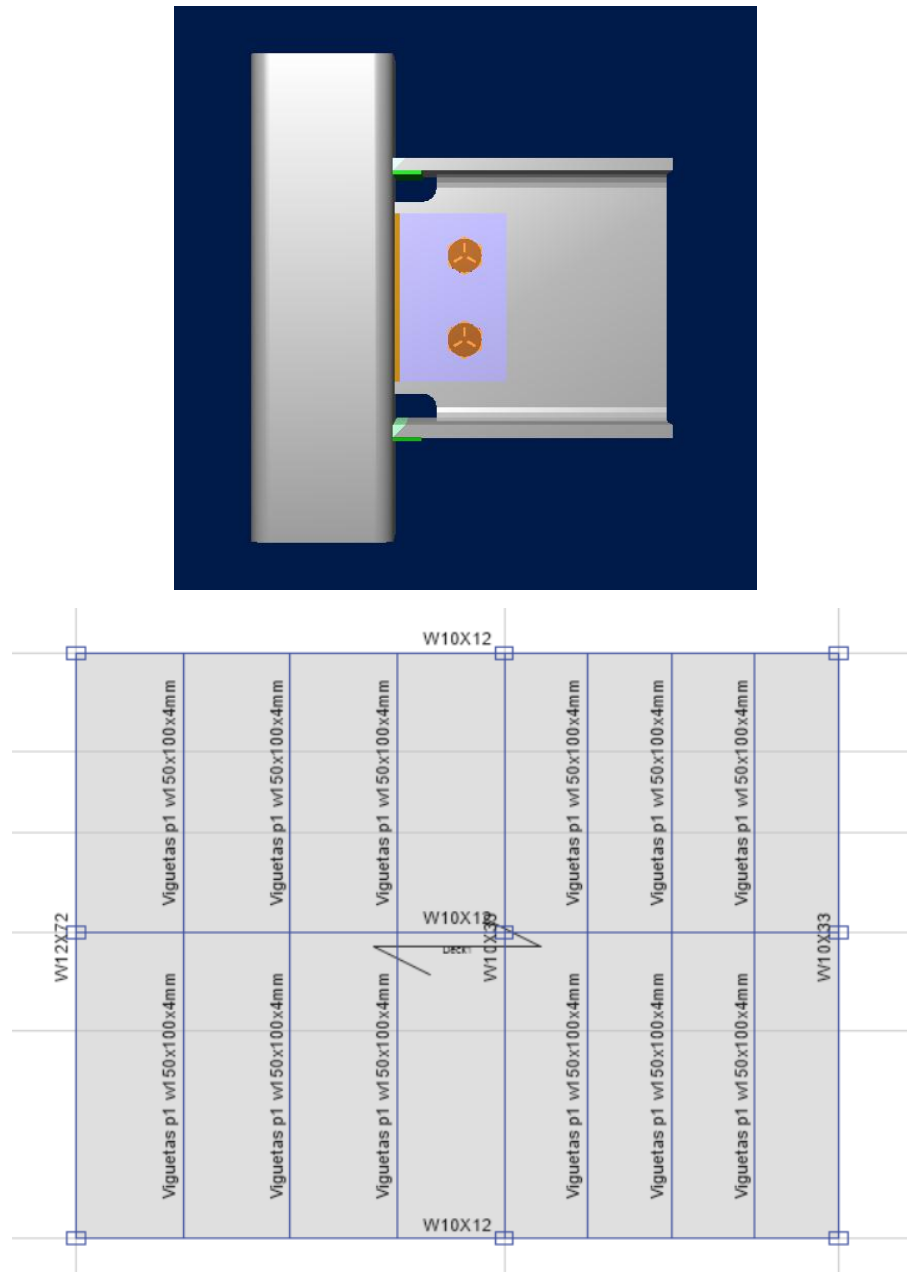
Conexión de Viga a Columna W10x33 – Col Hss 7x5x1/2
